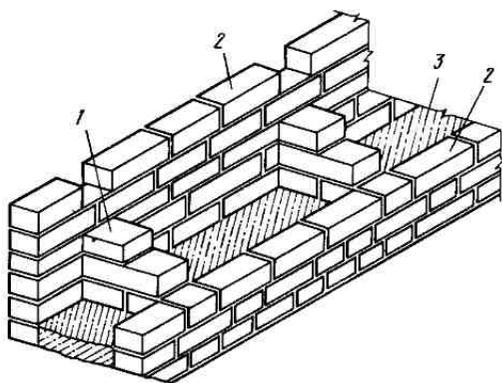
Конструкция облегченной кирпичной стены колодецевой кладки:
